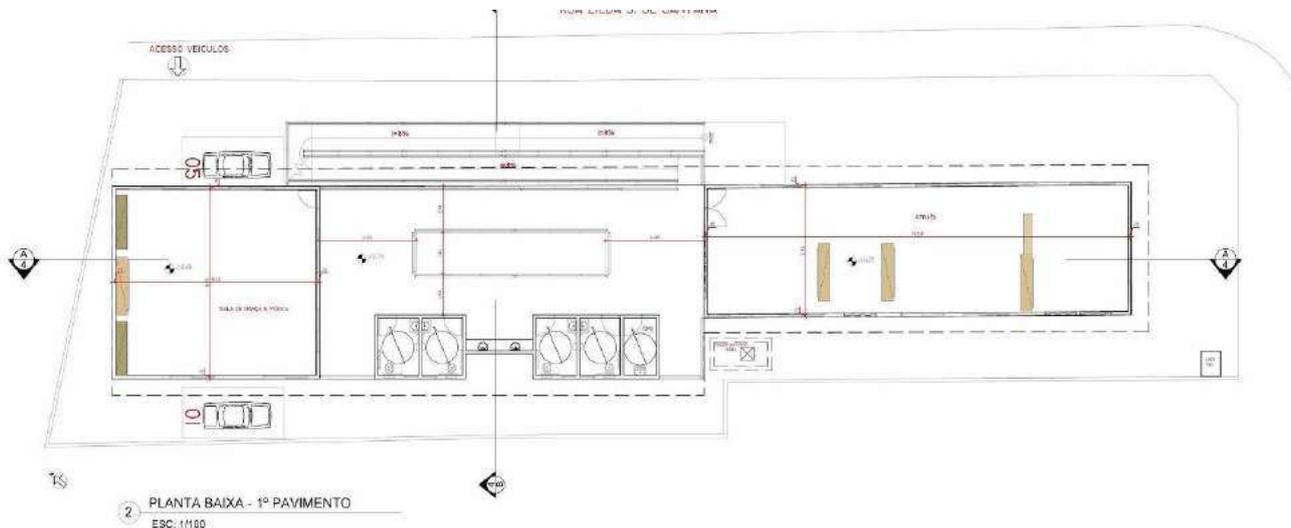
Fábrica de Cultura da Torre - Planta Baixa 1º Pavimento
